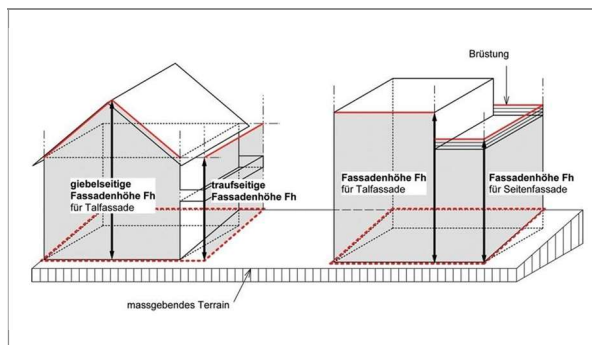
Anhang Baureglement 5.2: Fassadenhöhe
